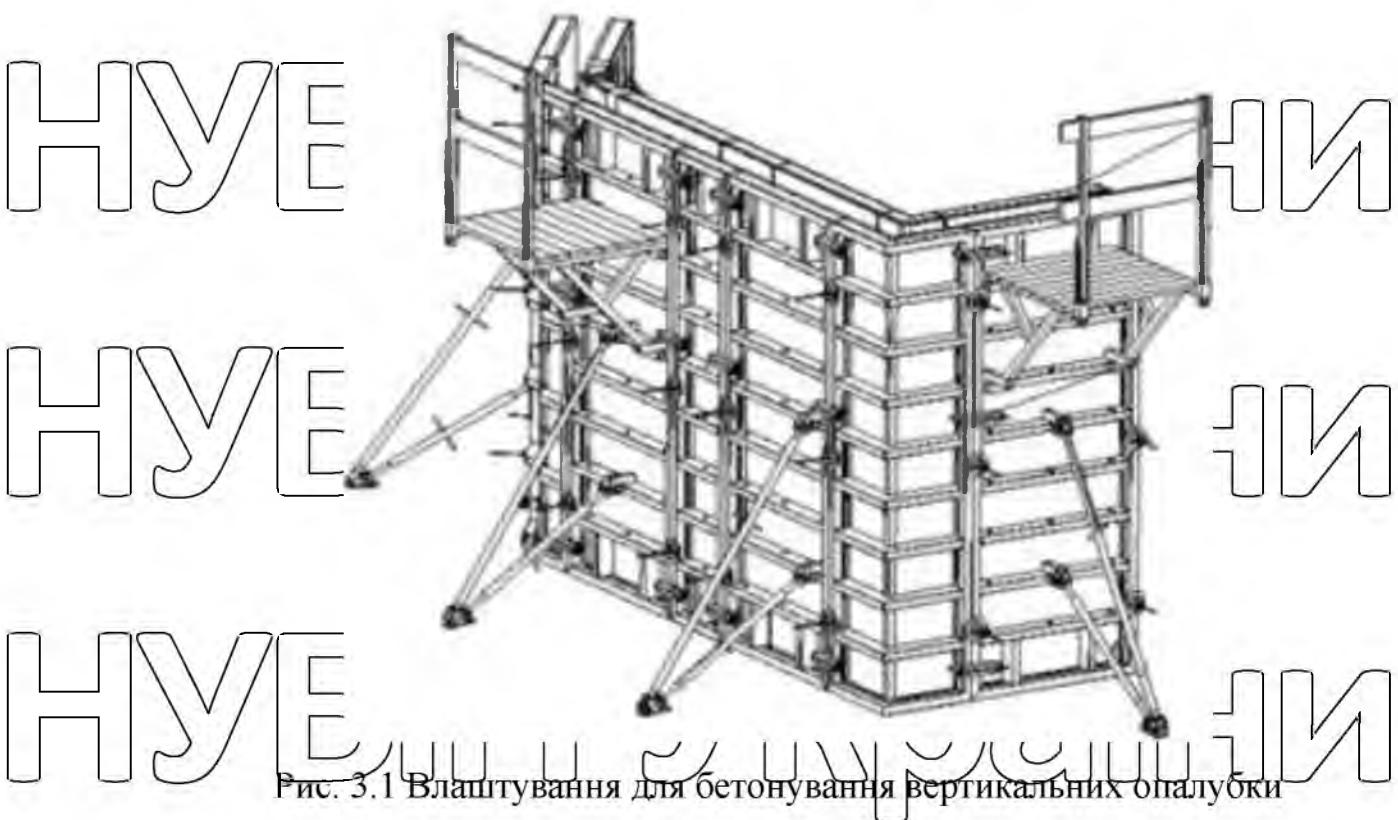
Влаштування для бетонування вертикальних опалубки конструкцій
